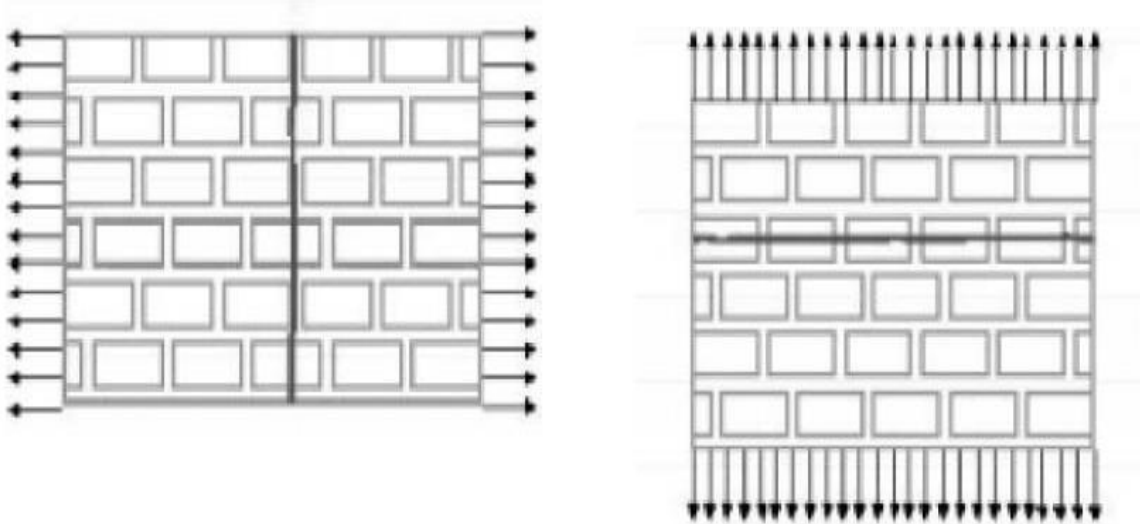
Falla cuando las unidades de mampostería son más fuertes (Fuente: Giraldo y Méndez, 2006)
